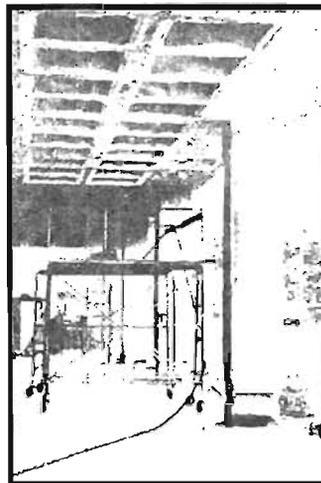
Figura III.XI Desconchamiento de una losa nervada en la planta baja de un edificio administrativo por efectos de incendio.
